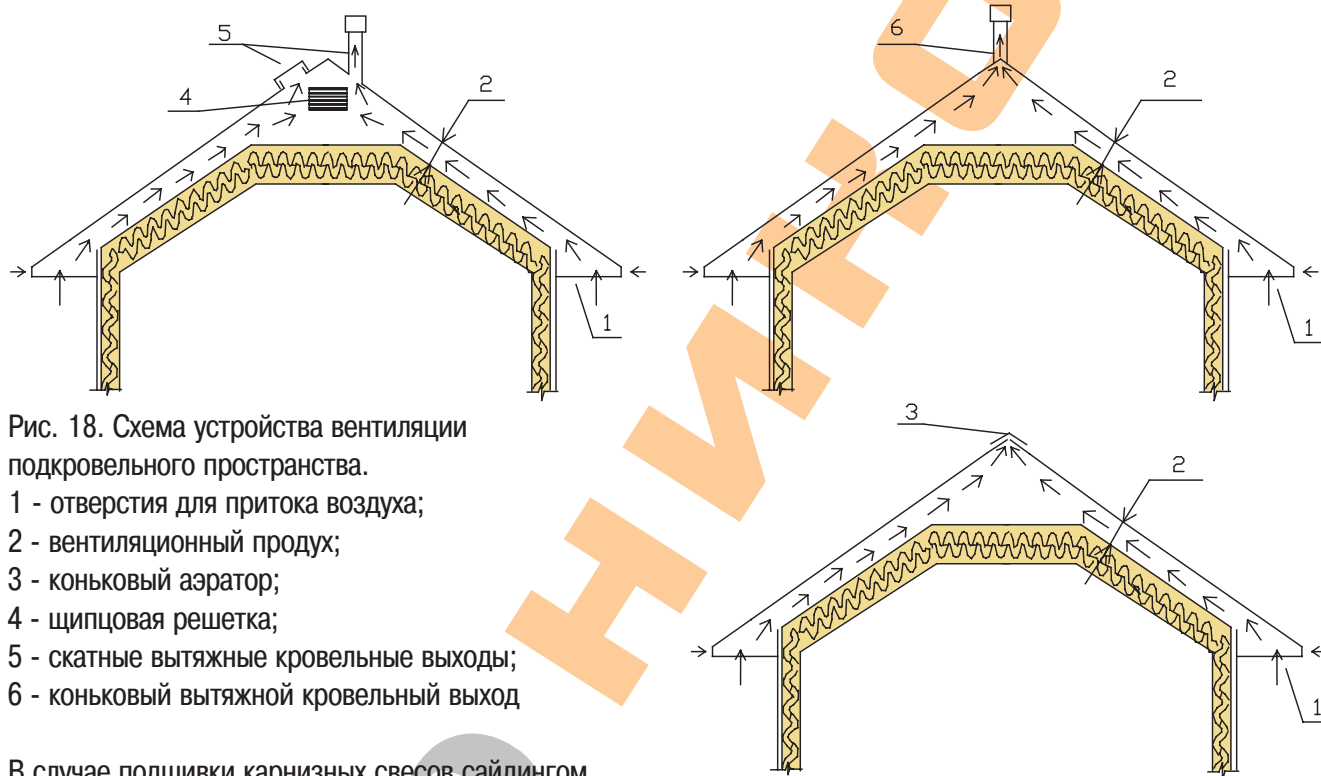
Схема устройства вентиляции подкровельного пространства.
